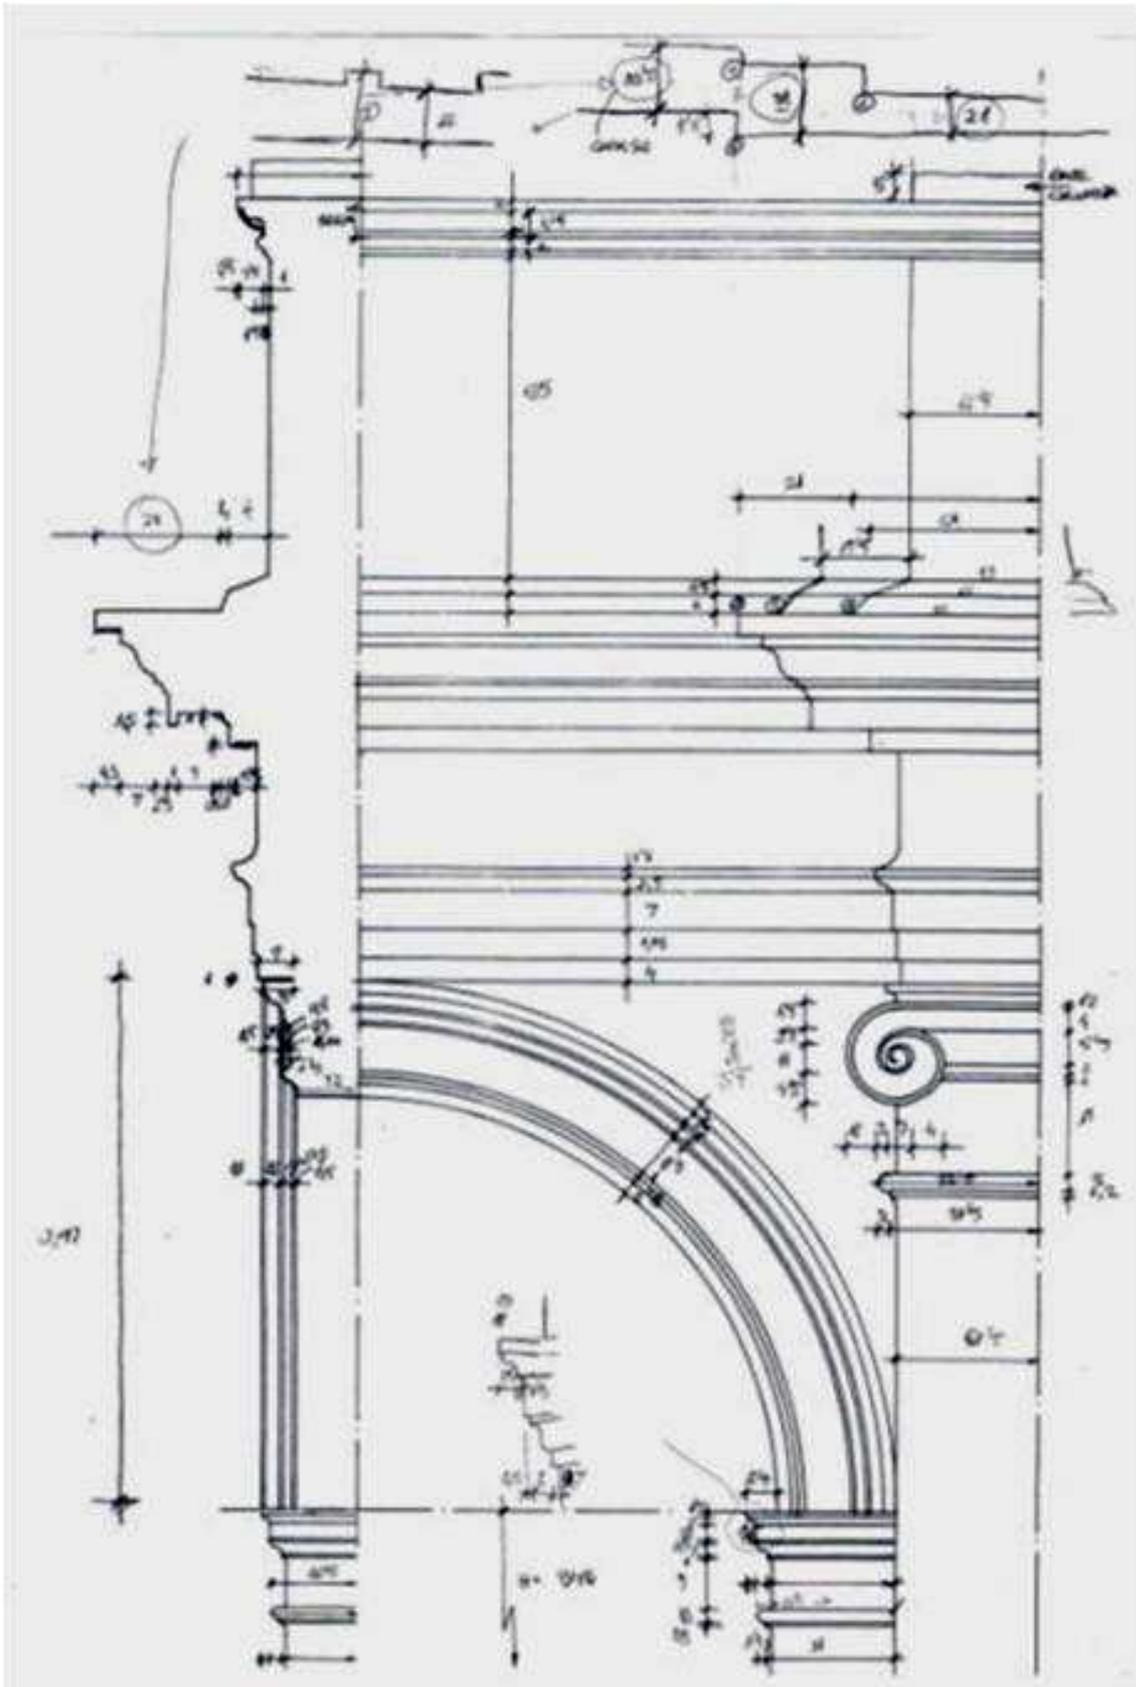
24.4 Detalle de arco de planta segunda y antepecho de última planta.
